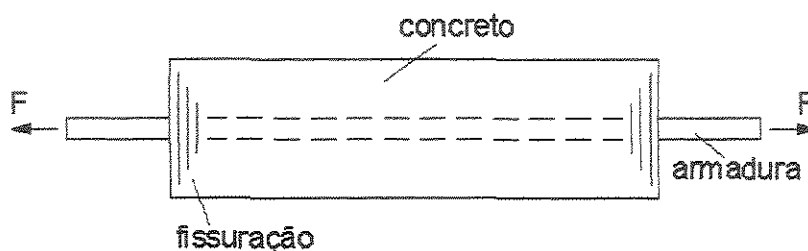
Fissuração – aderência perfeita.
